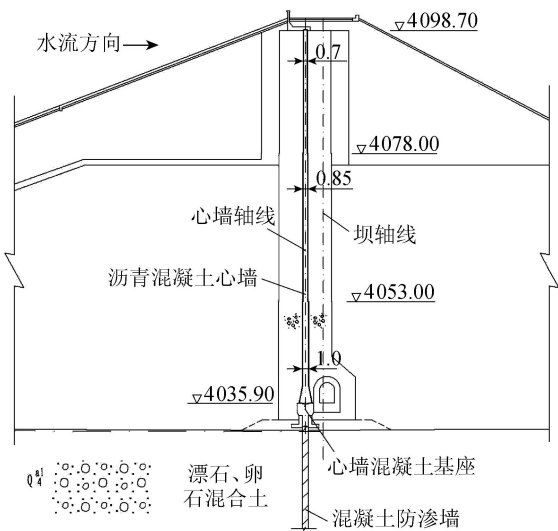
旁多水利枢纽大坝碾压式沥青混凝土心墙典型断面 (单位:m)
